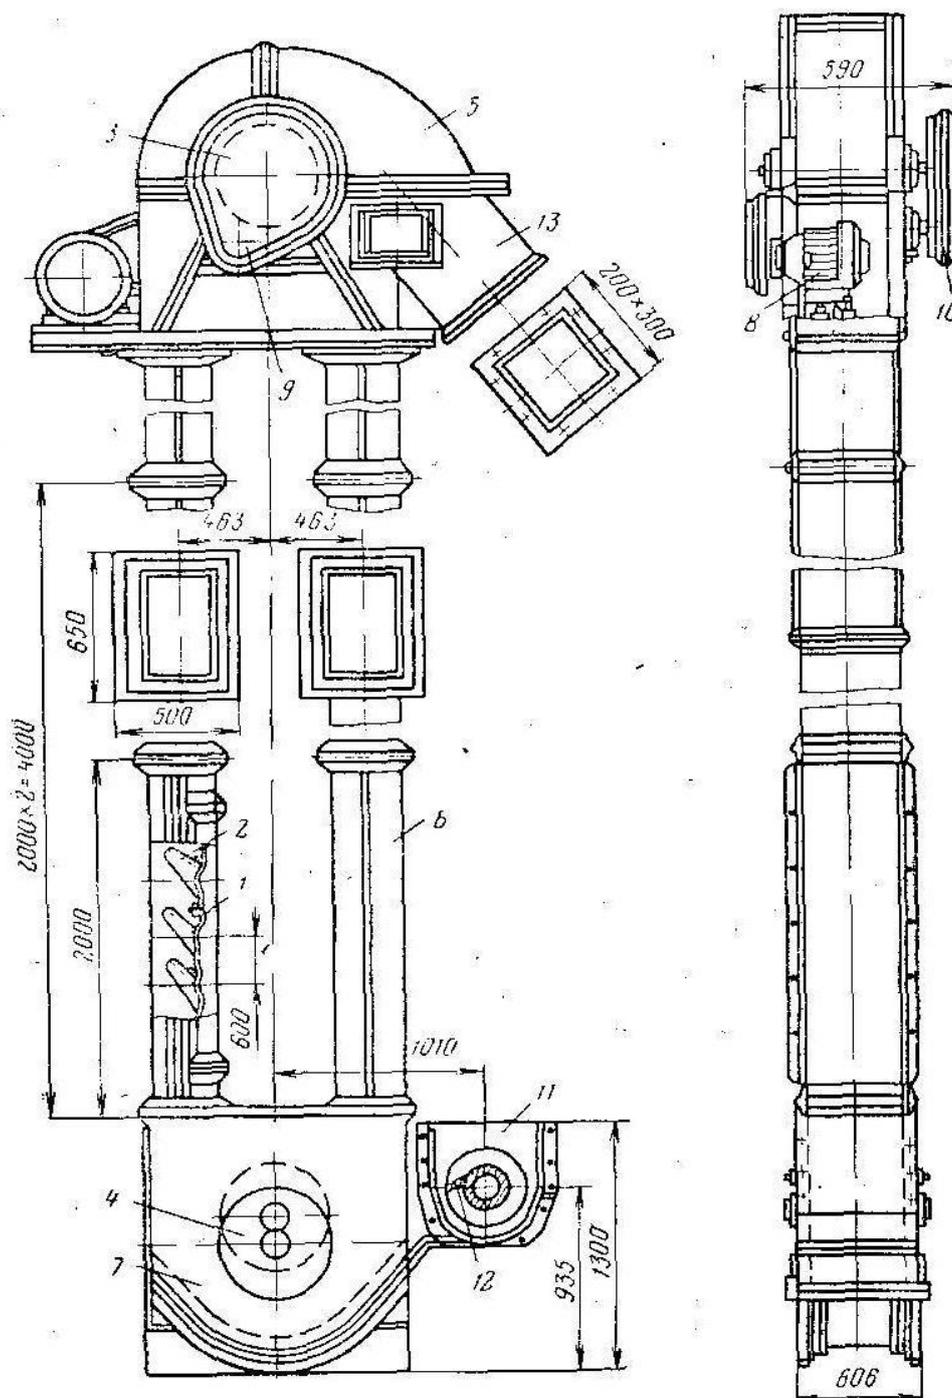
Схема элеватора ЭХ-15 для хлопка-сырца
